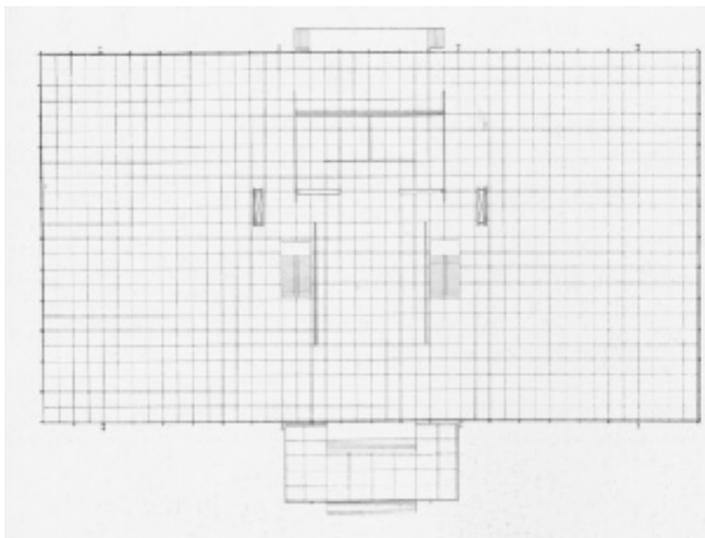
Mies van der Rohe, Crow Hall – Planta baixa do térreo, Chicago, 1950
